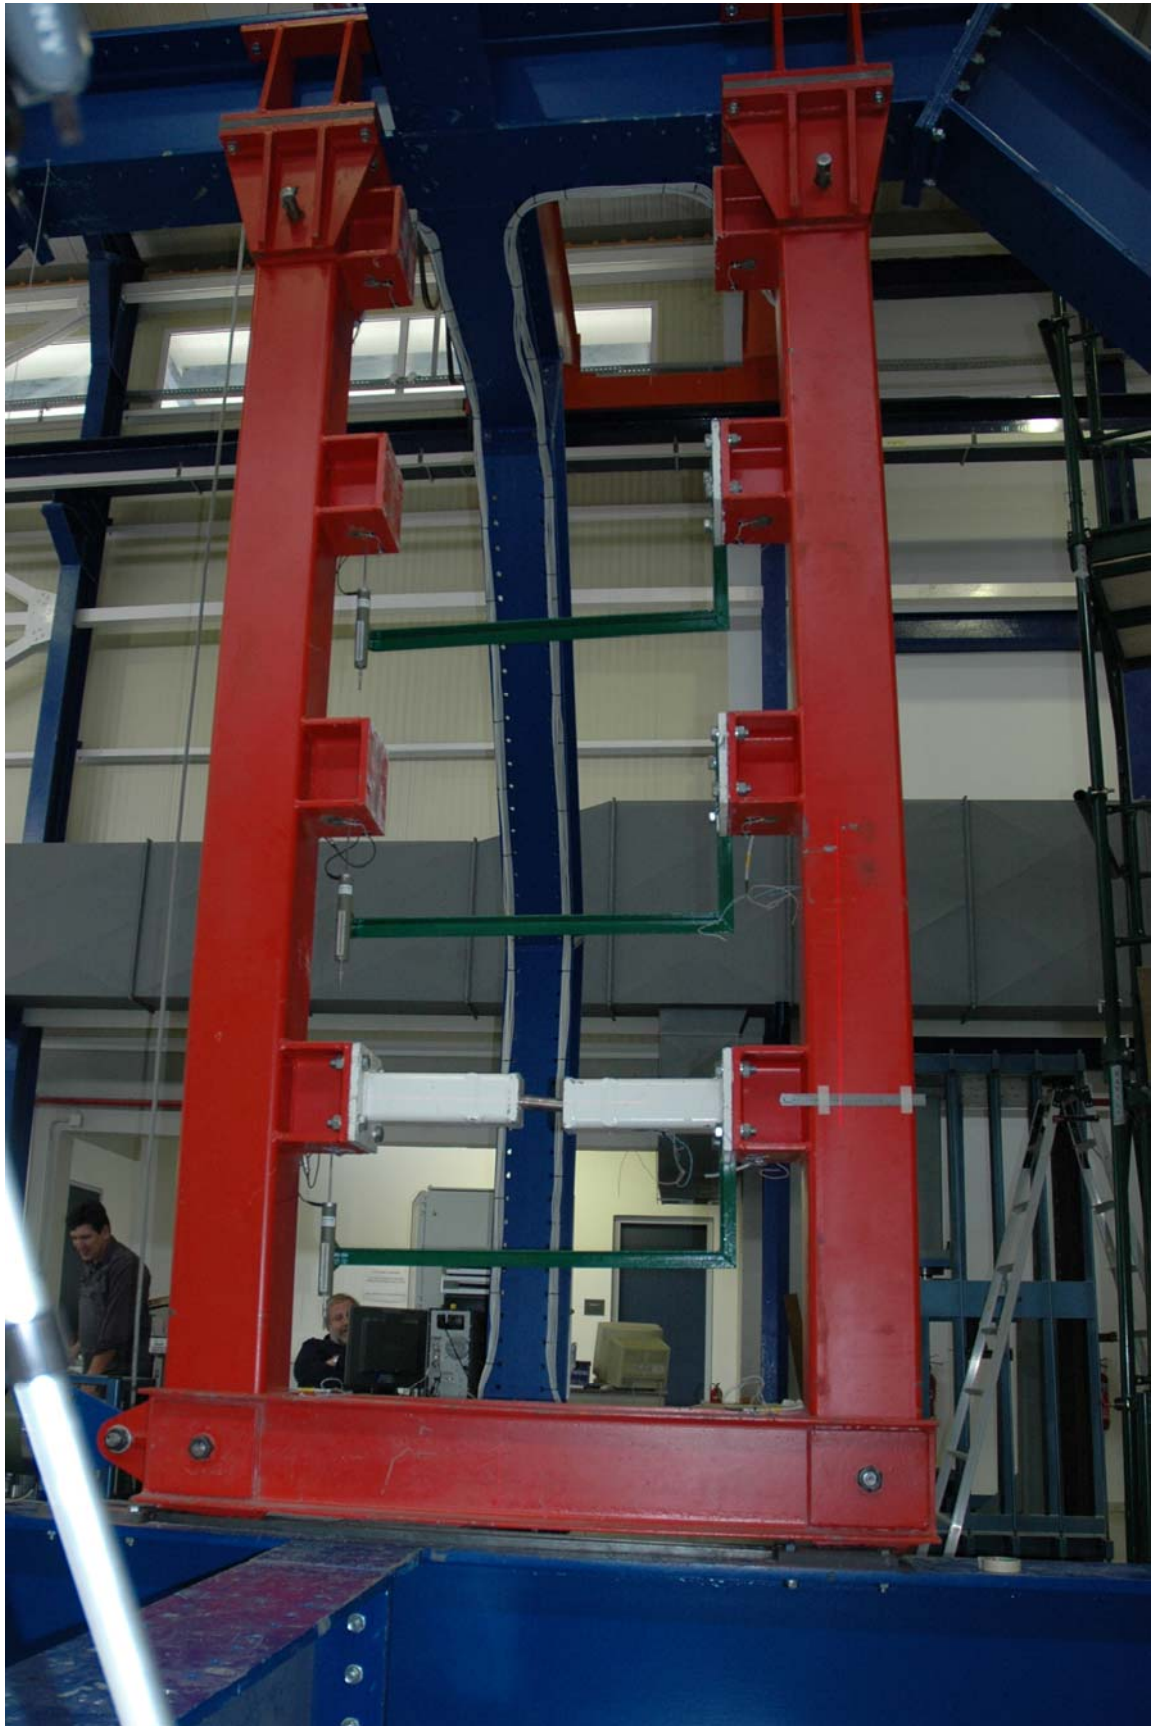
Τα δοκίμια του πειράματος 1 ROD Φ33 double screw-impact
